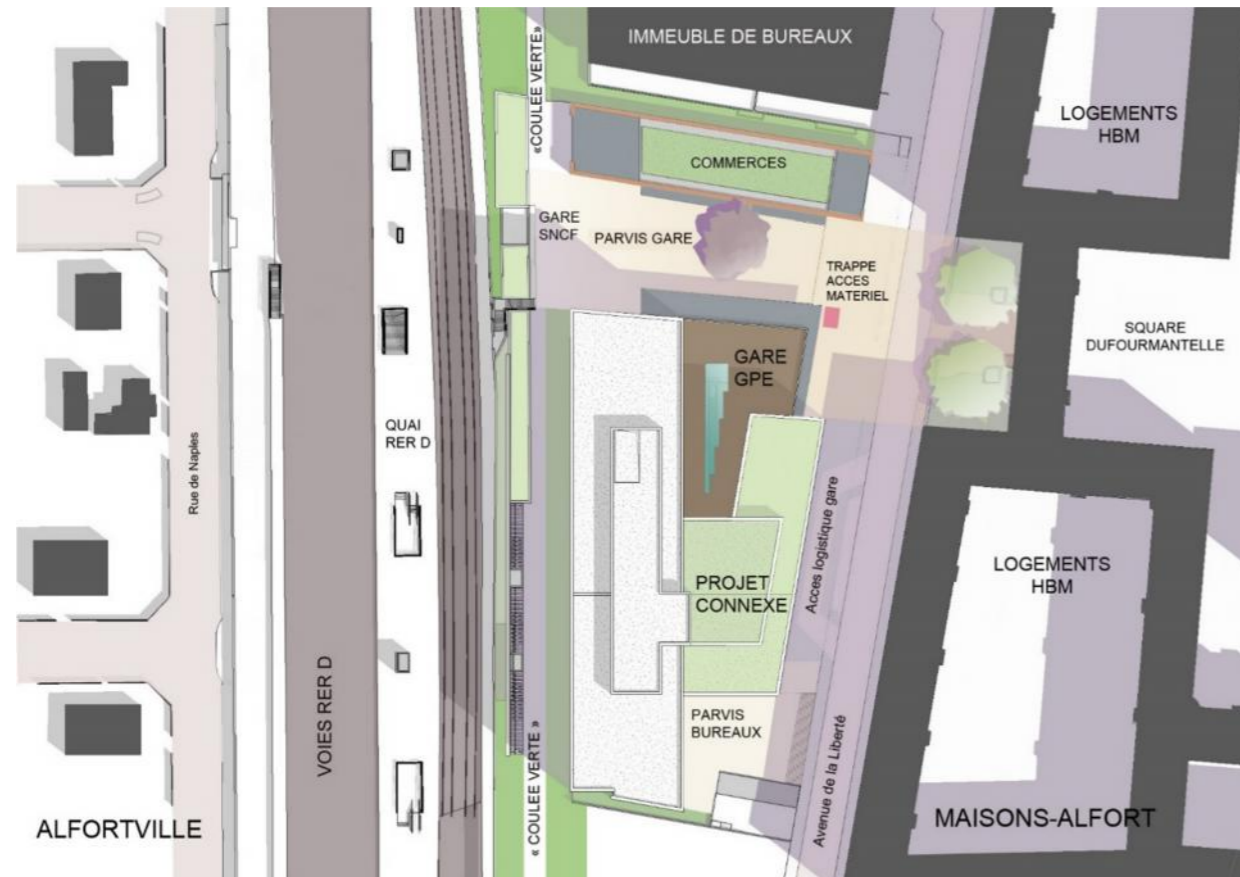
Plan masse à l'échelle 1/500ème - VPA. 23/12/2014
